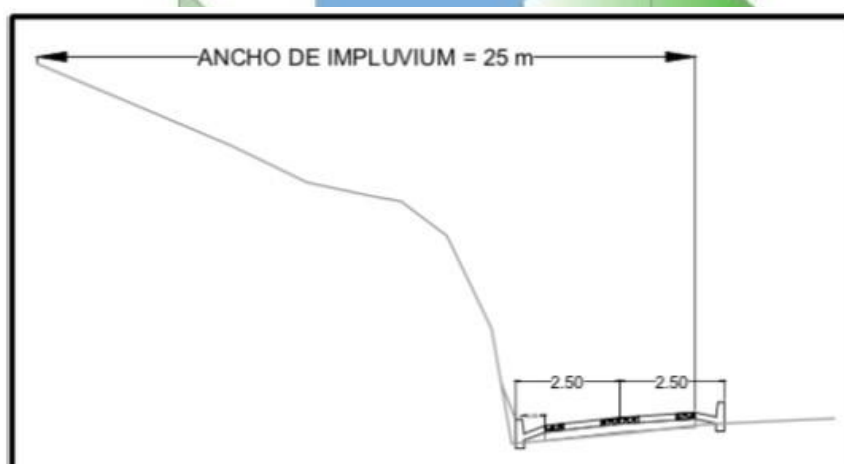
Ancho Impluvium. Fuente: Guía de Diseño de Pavimentos
